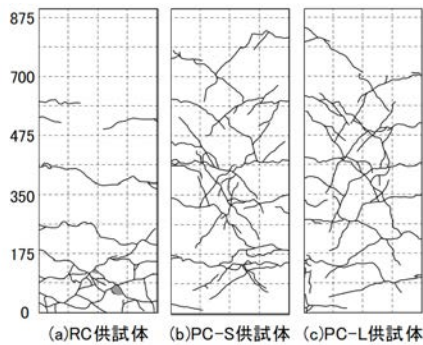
ひび割れ図 (ドリフト 3.0%)
